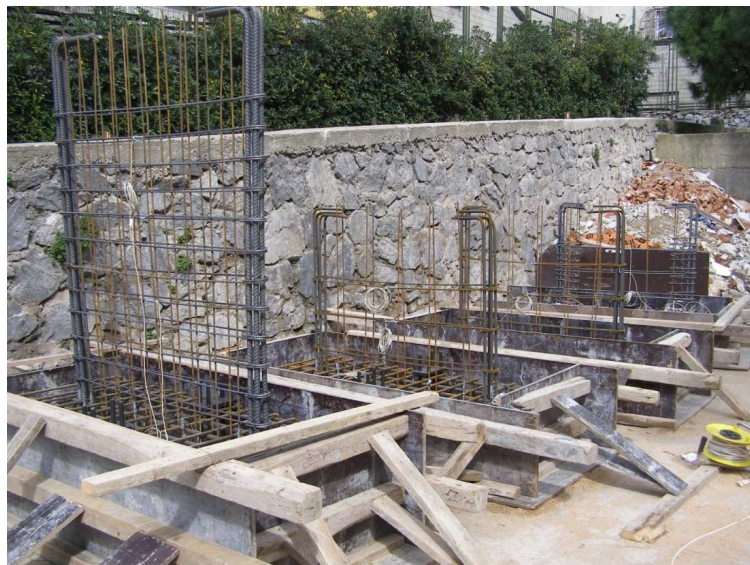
Moldaje inferior y preparación de armadura del muro (Terzioğlu, 2011).
